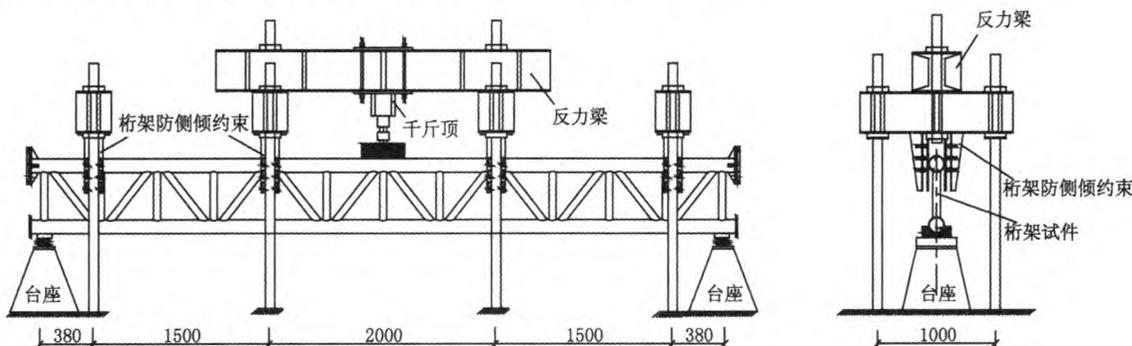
钢管混凝土桁梁试件及加载装置 (单位: mm)
